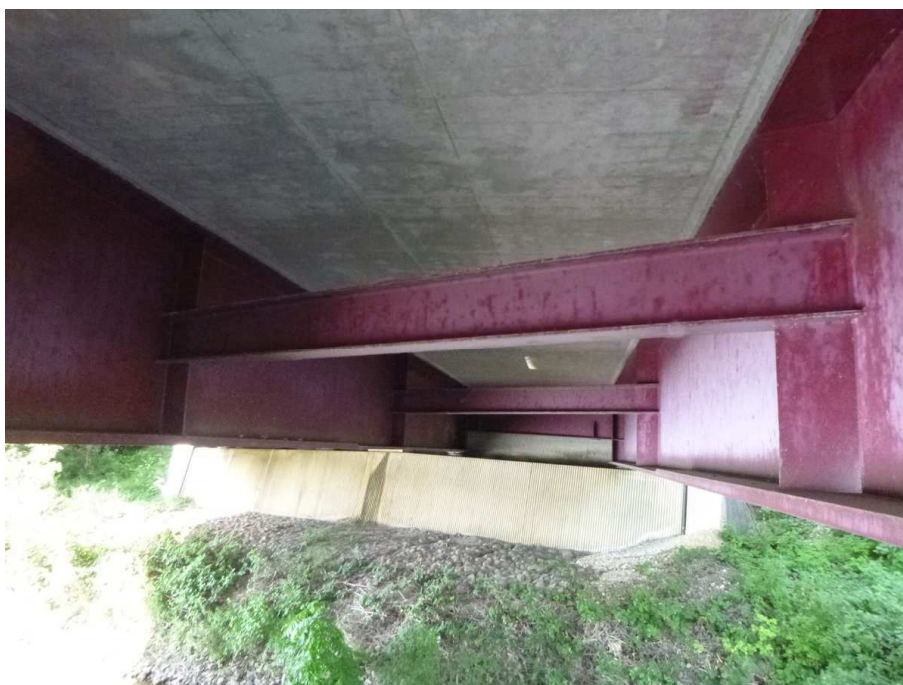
Vue générale – Ecaillage par piqûres de corrosion sur âme et chant de semelle inférieure - Po3 face aval – Culée C0
